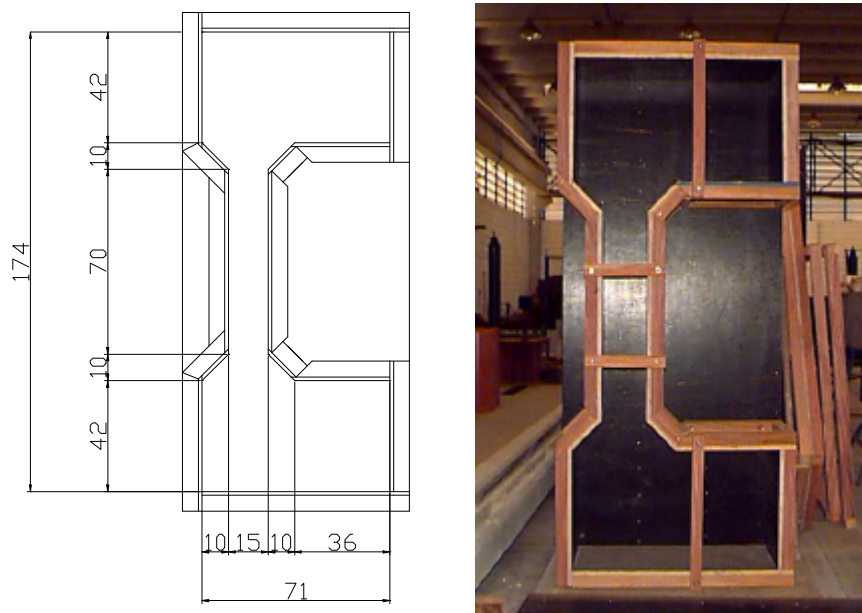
Fôrma usada para concretagem dos pilares
